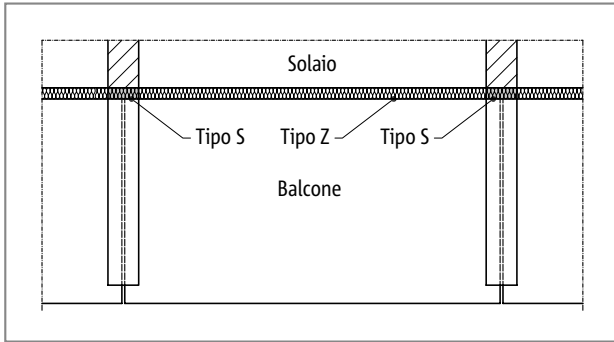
Schöck Isokorb® tipo S, balcone con travi a sbalzo (balcone prefabbricato)
